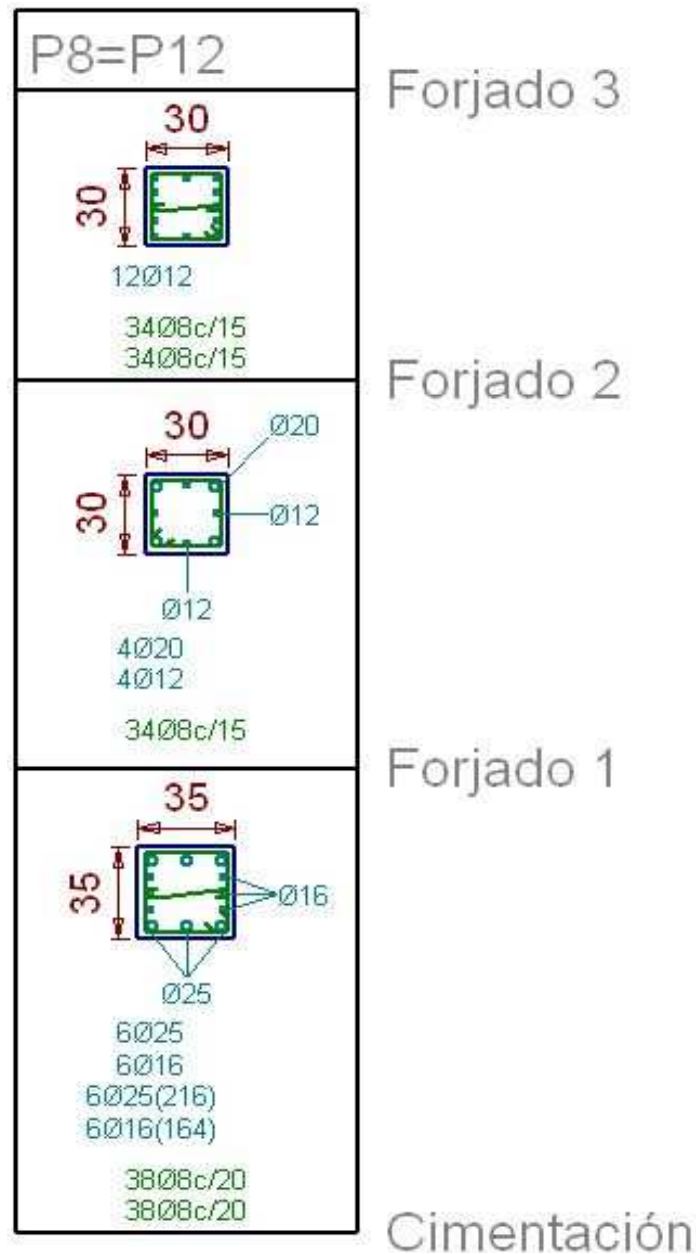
Armadura en pilares (2). Edificio de 3 plantas.
